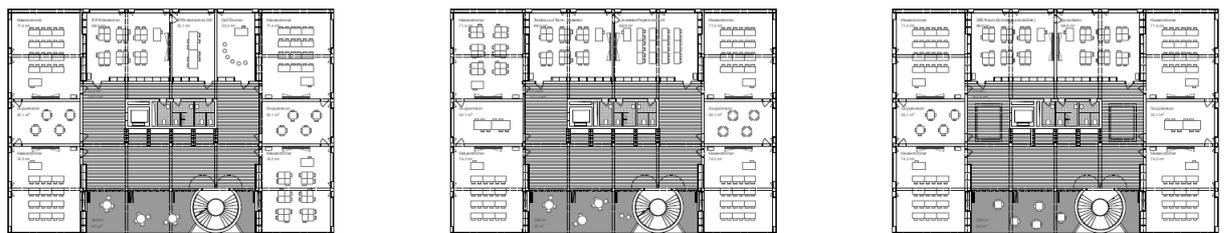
Grundrisse Ebenen 3 bis 5
